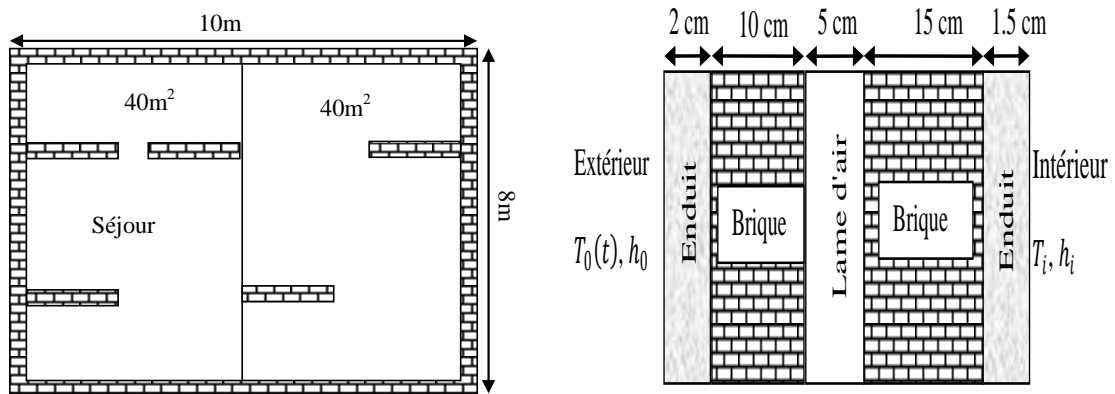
Plan du logement typique et structure du mur extérieur (Ghedamsi R et al, 2016).
